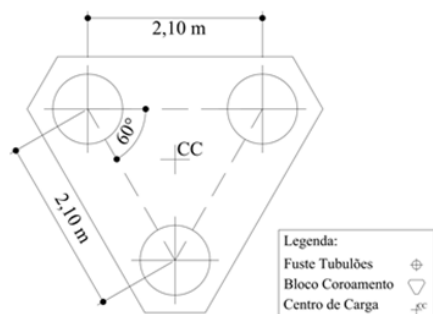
Planta dos Tubulões e Bloco de Coroamento.
